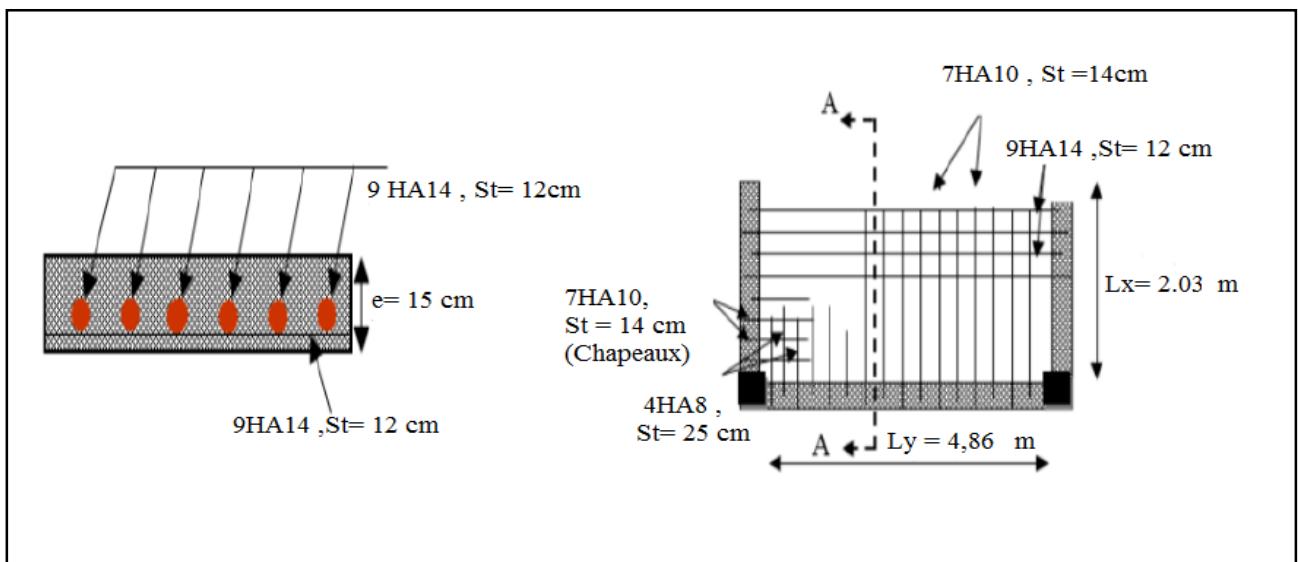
Schéma de ferrailage de la dalle sur 3 appuis
